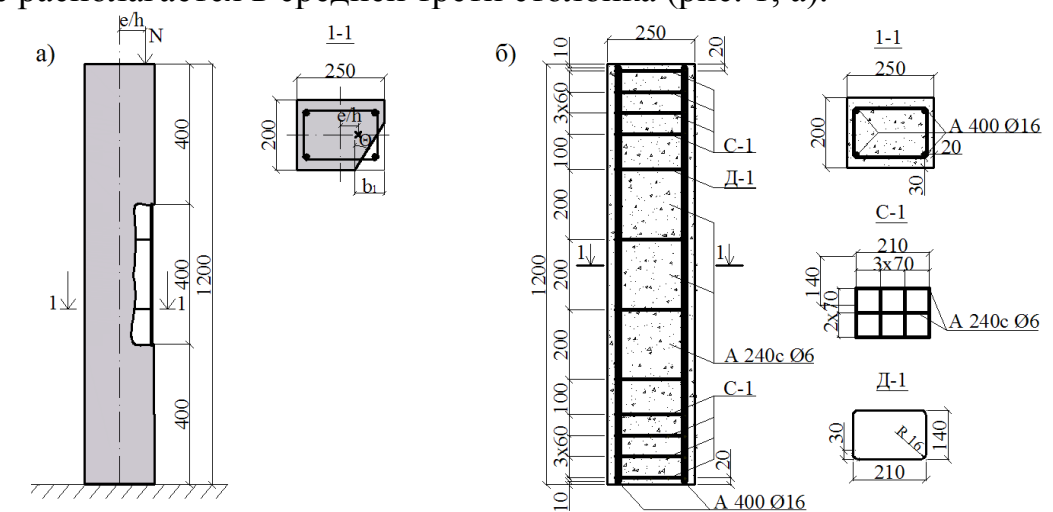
Опытный образец: а – общий вид поврежденного элемента; б – схема армирования
